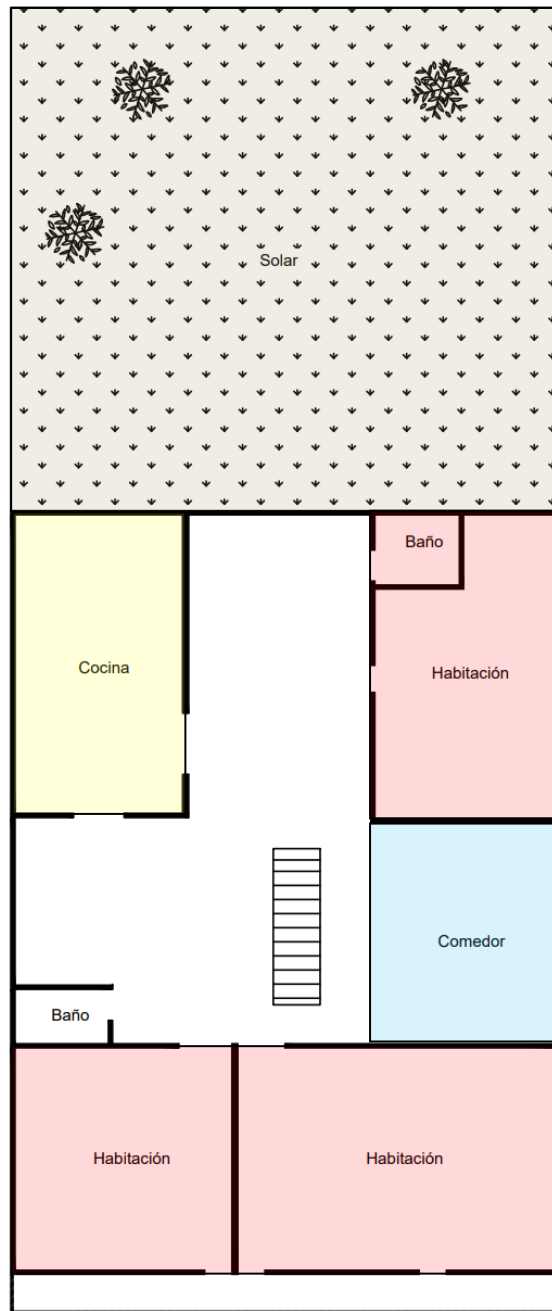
cuarta planta actual. Fuente: elaboracion propia.
